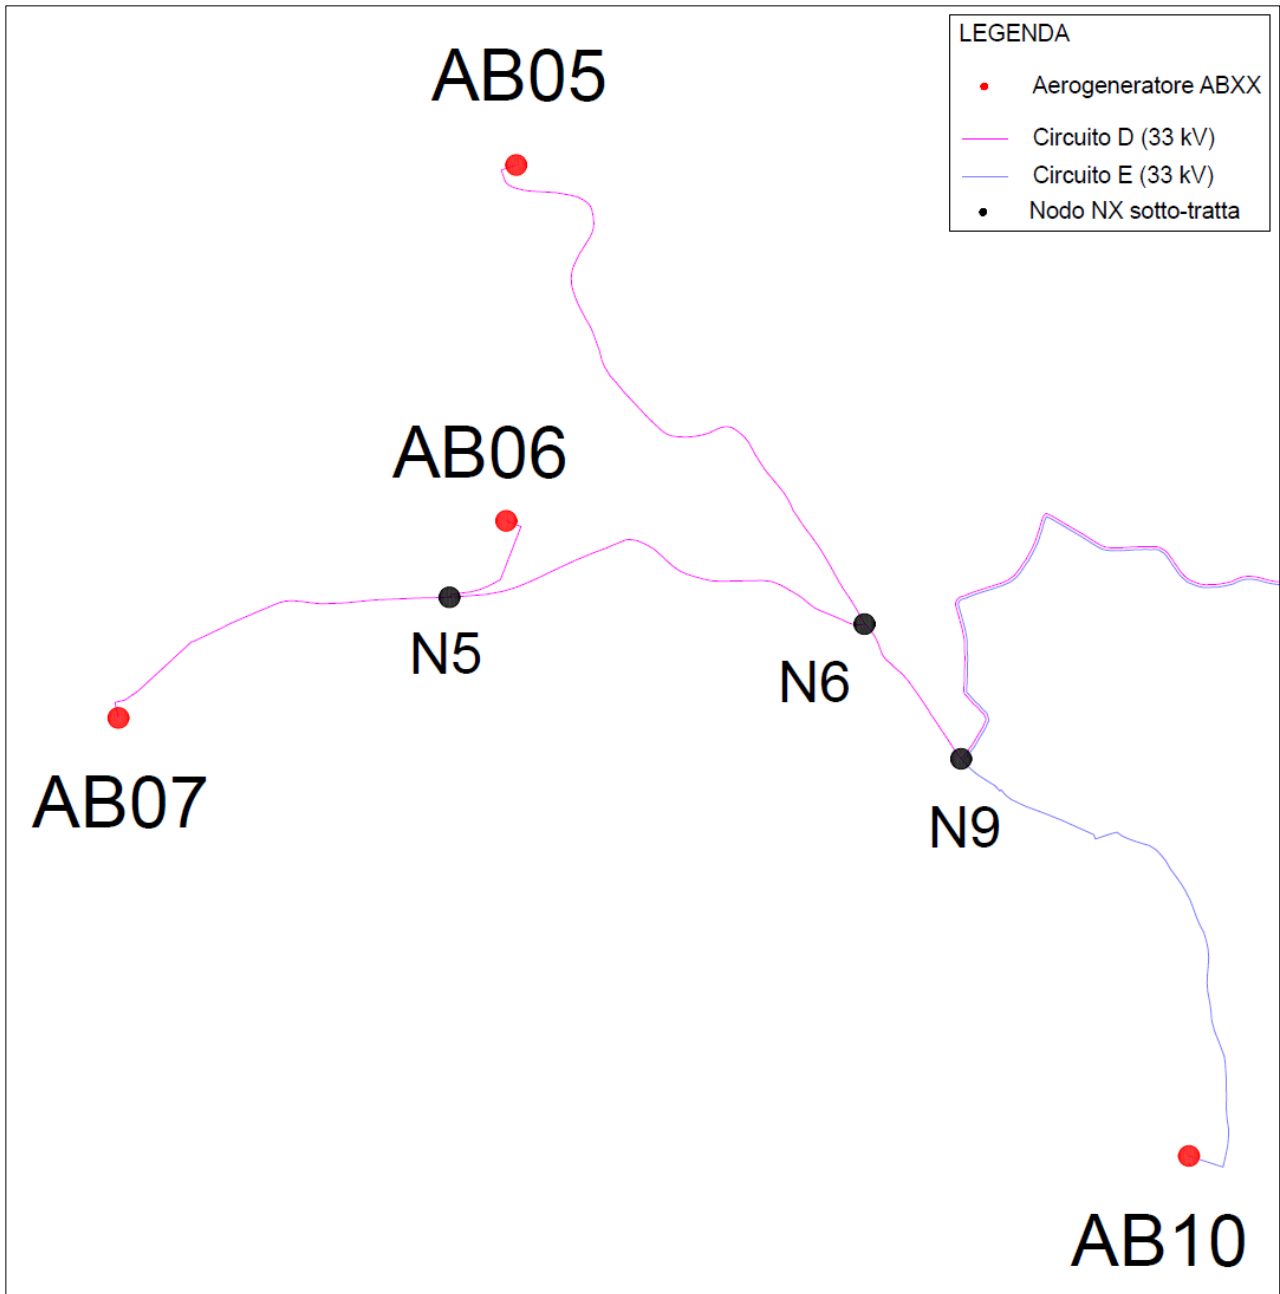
Dettaglio 2 di 4 della planimetria generale di distribuzione linee elettriche
